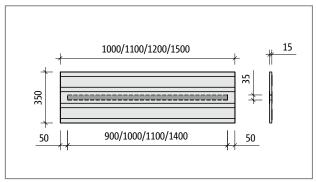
Schöck Tronsole® tipo B-V2-L...-B350, pianta del prodotto
